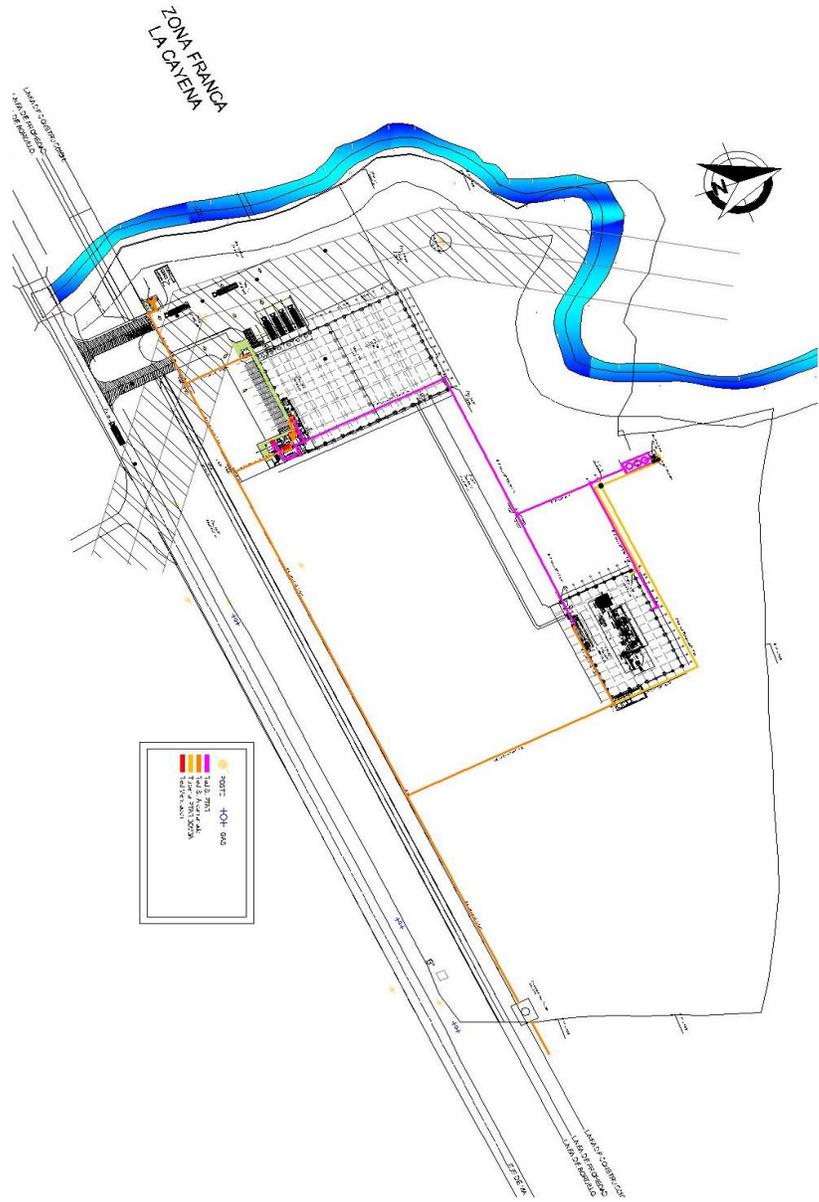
Plano con primera propuesta de trazado de alcantarillado sanitario. Fuente: PERWING LTDA.
